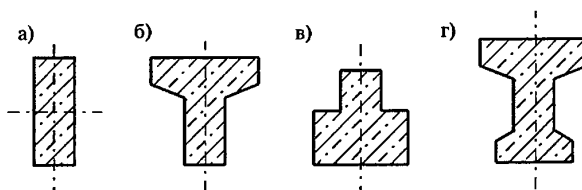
Сечения железобетонных балок: а) прямоугольное; б) тавровое; в) тавровое с полкой внизу; г) двутавровое
